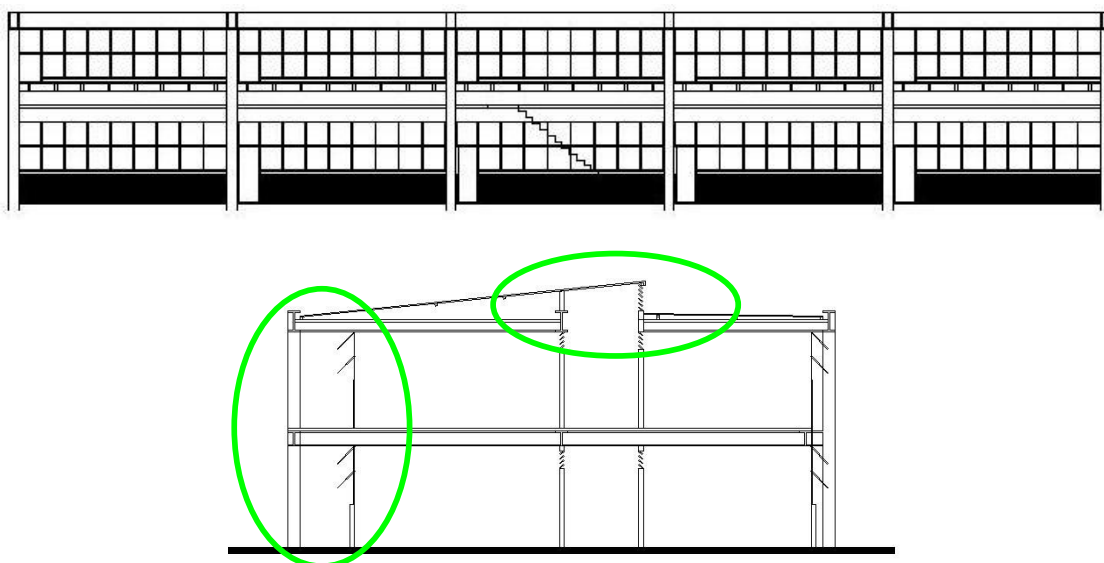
Fachada norte e corte mostrando a ventilação zenital na cobertura e beiral maior na fachada norte
